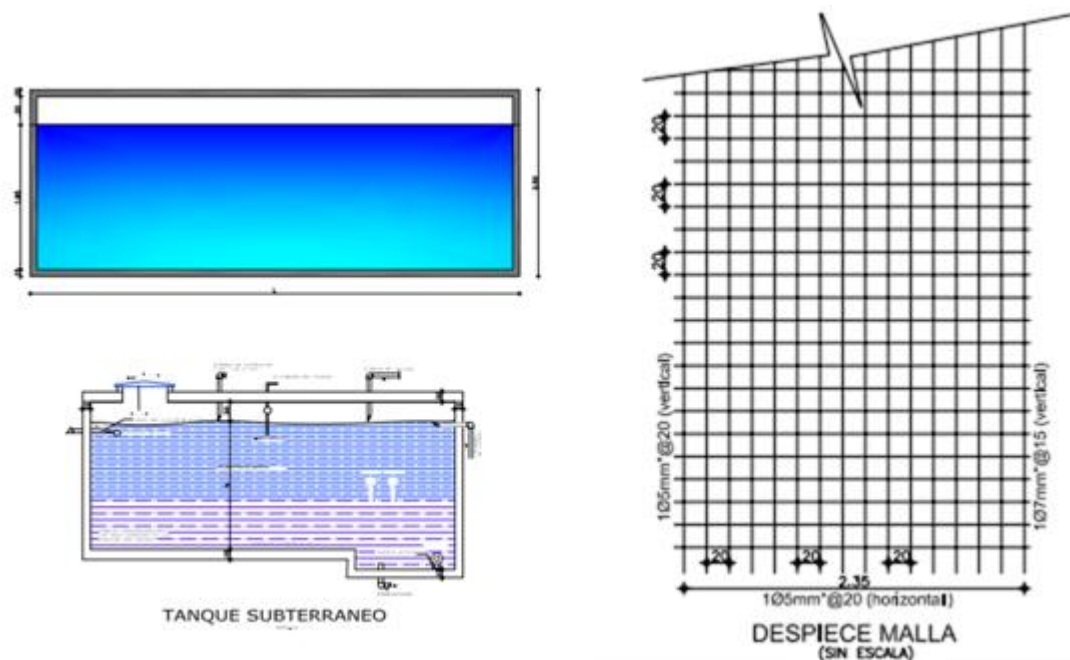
Obra central Park fase II, sótano -4, plano de cimentación y diseño de tanque subterráneo.
